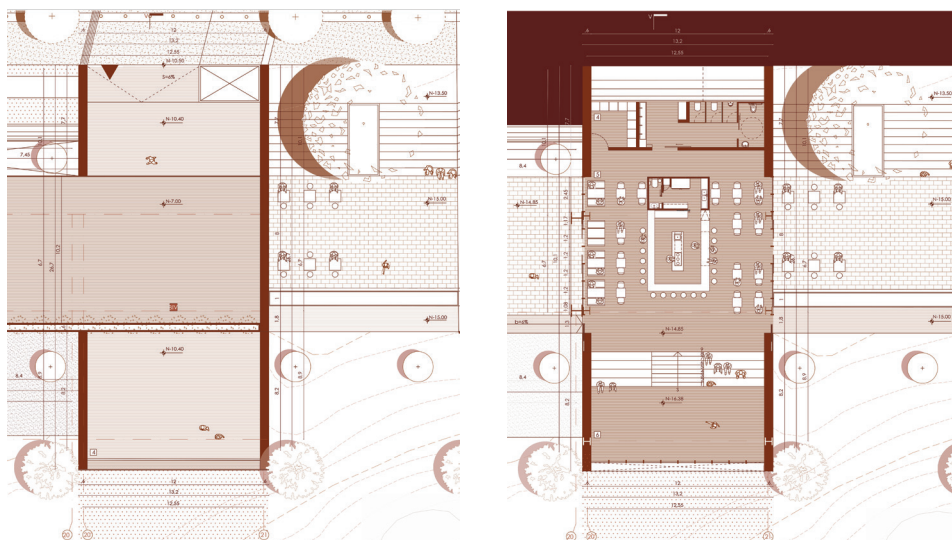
Bloque IV. Planta de cubierta N-10.40. y Planta N-14.85
